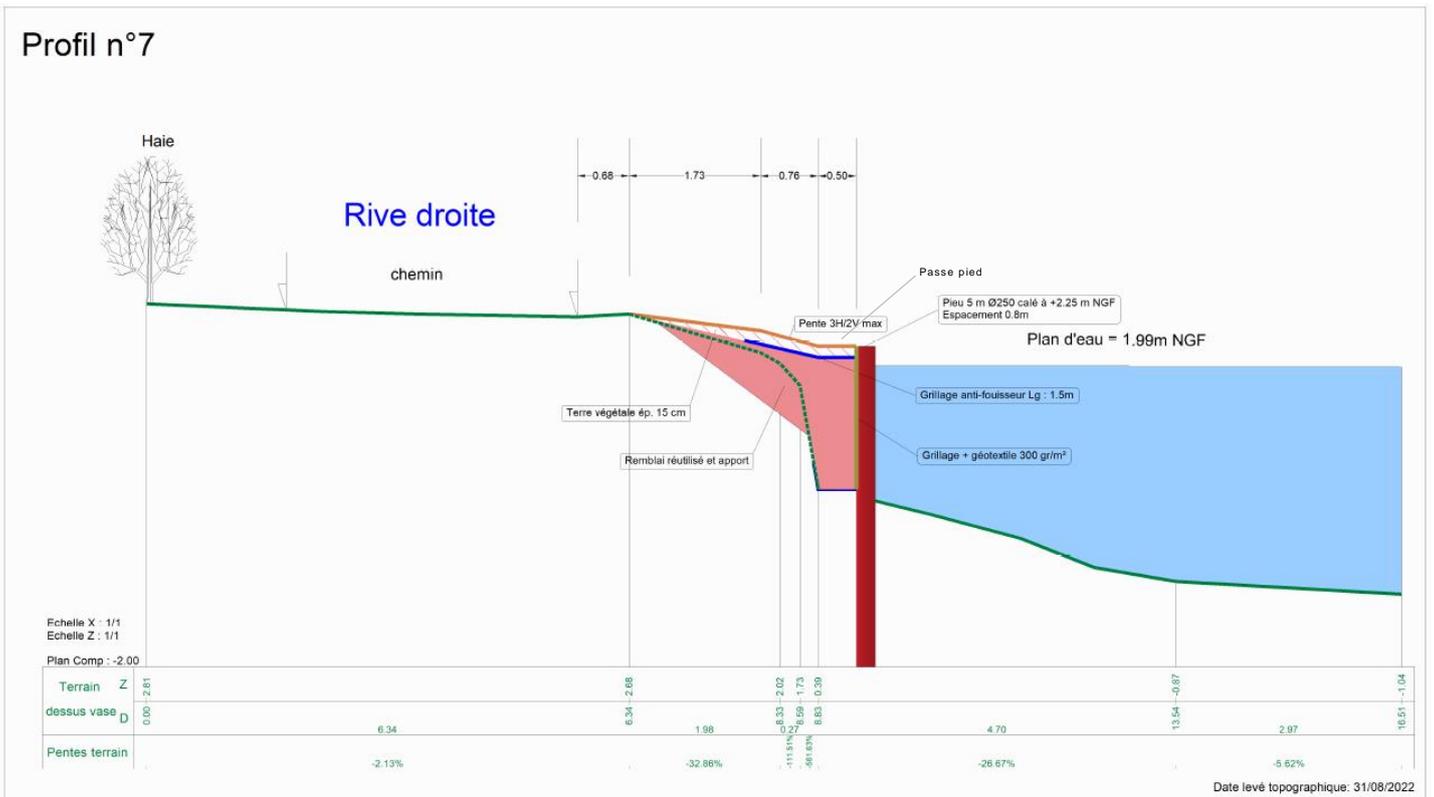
Exemple d'un profil en travers aménagé en pieux sur la zone 1.1.3_Loup
